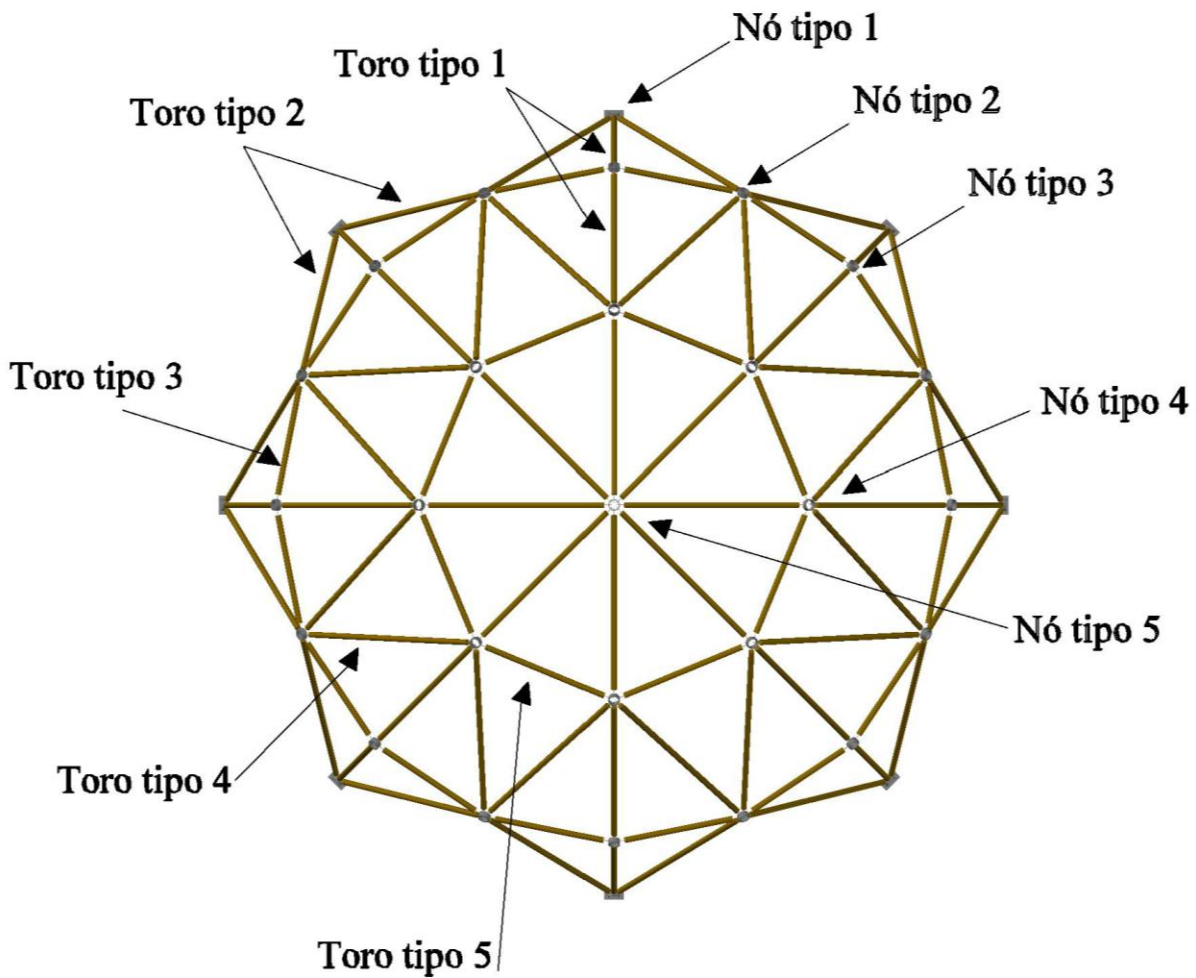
Vista de topo da estrutura piloto proposta com identificação dos nós de ligação e elementos estruturais
